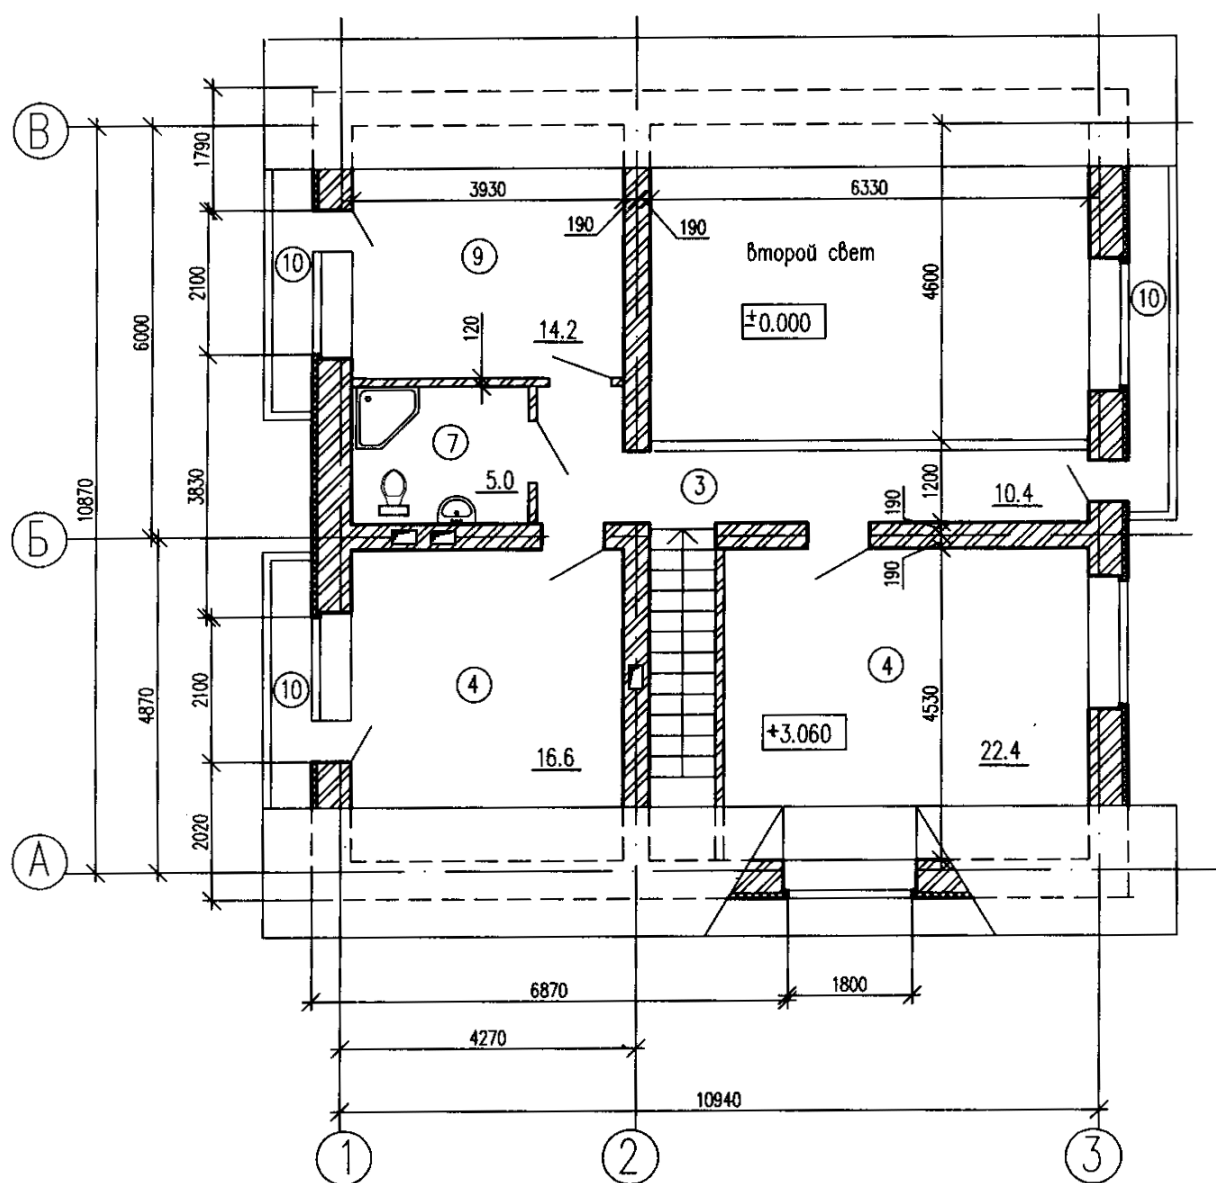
Пример выполнения плана 2-го этажа (M1:200)
